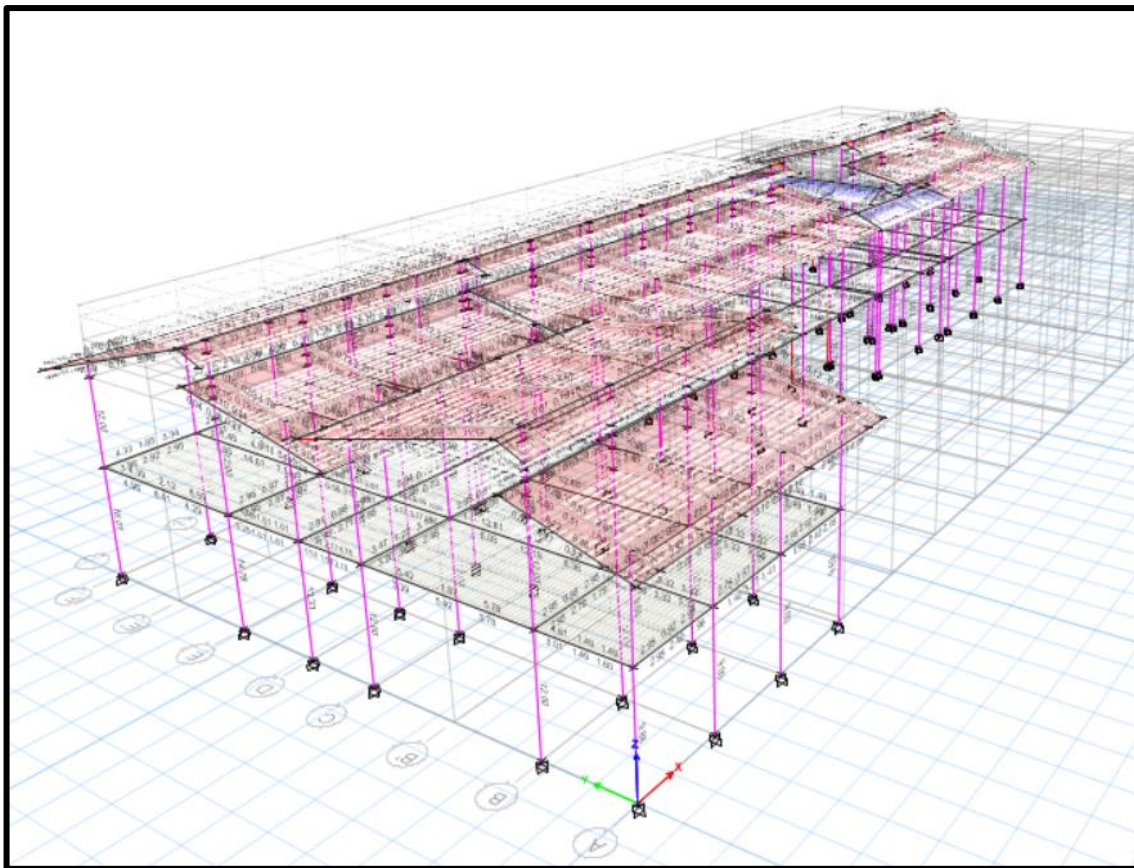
Consideraciones para el diseño y cálculo estructural para un sistema Aporticado de Concreto Armado
